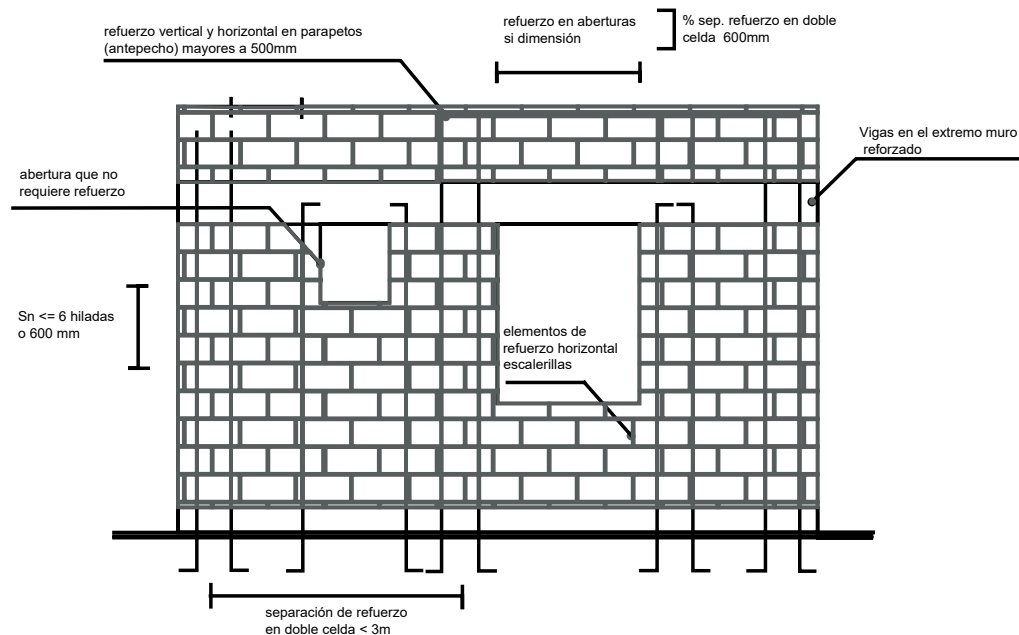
Distribución de refuerzo Vertical y Horizontal. Detalles de encuentro de muros
